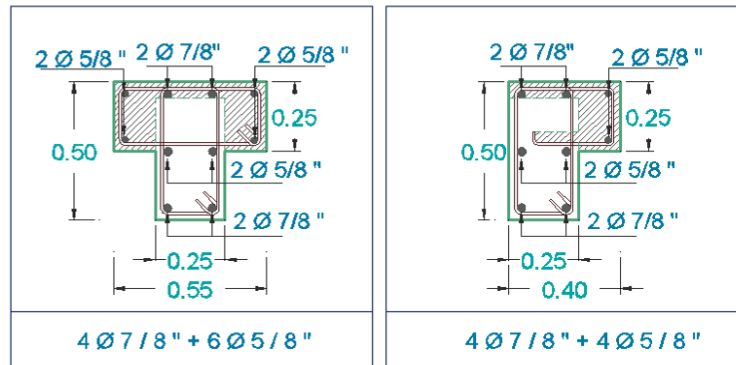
REFORZAMIENTO DE LAS COLUMNAS DEL PABELLÓN 1B.
